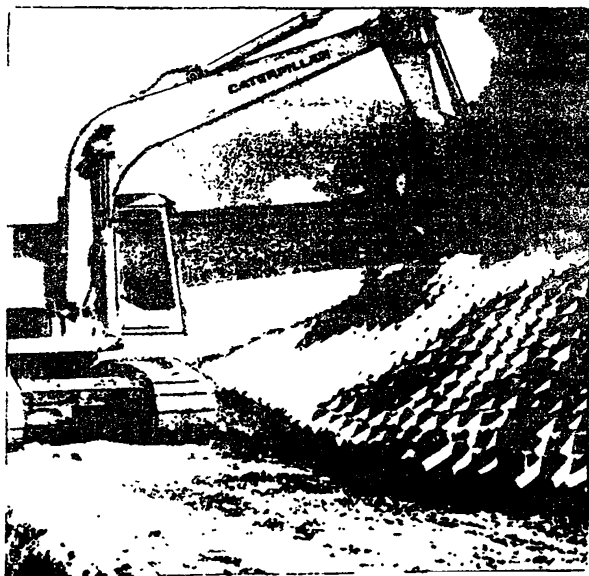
Засыпка георешеток типа Armater растительным грунтом.
